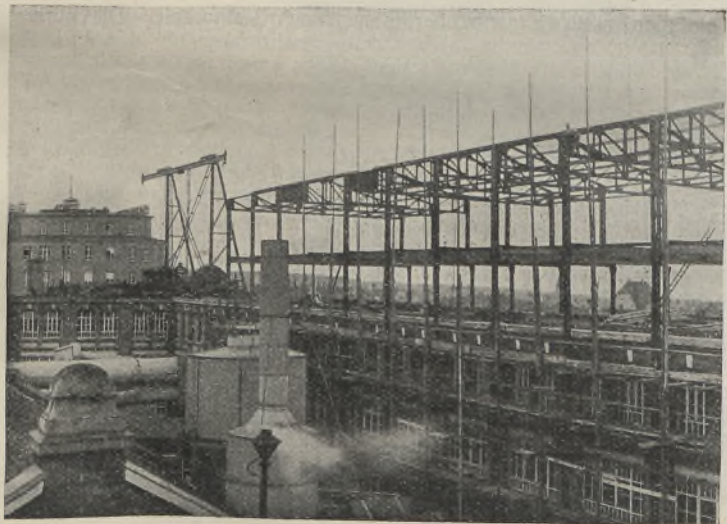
Aufstellung der Dach- und Stützenkonstruktion.
